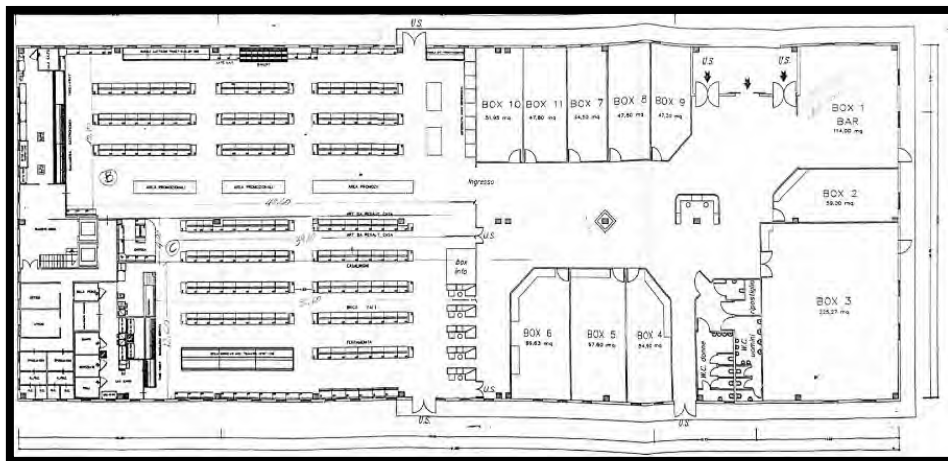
Pianta piano terra allegata alla DIA n. 8751 del 05/12/2006
